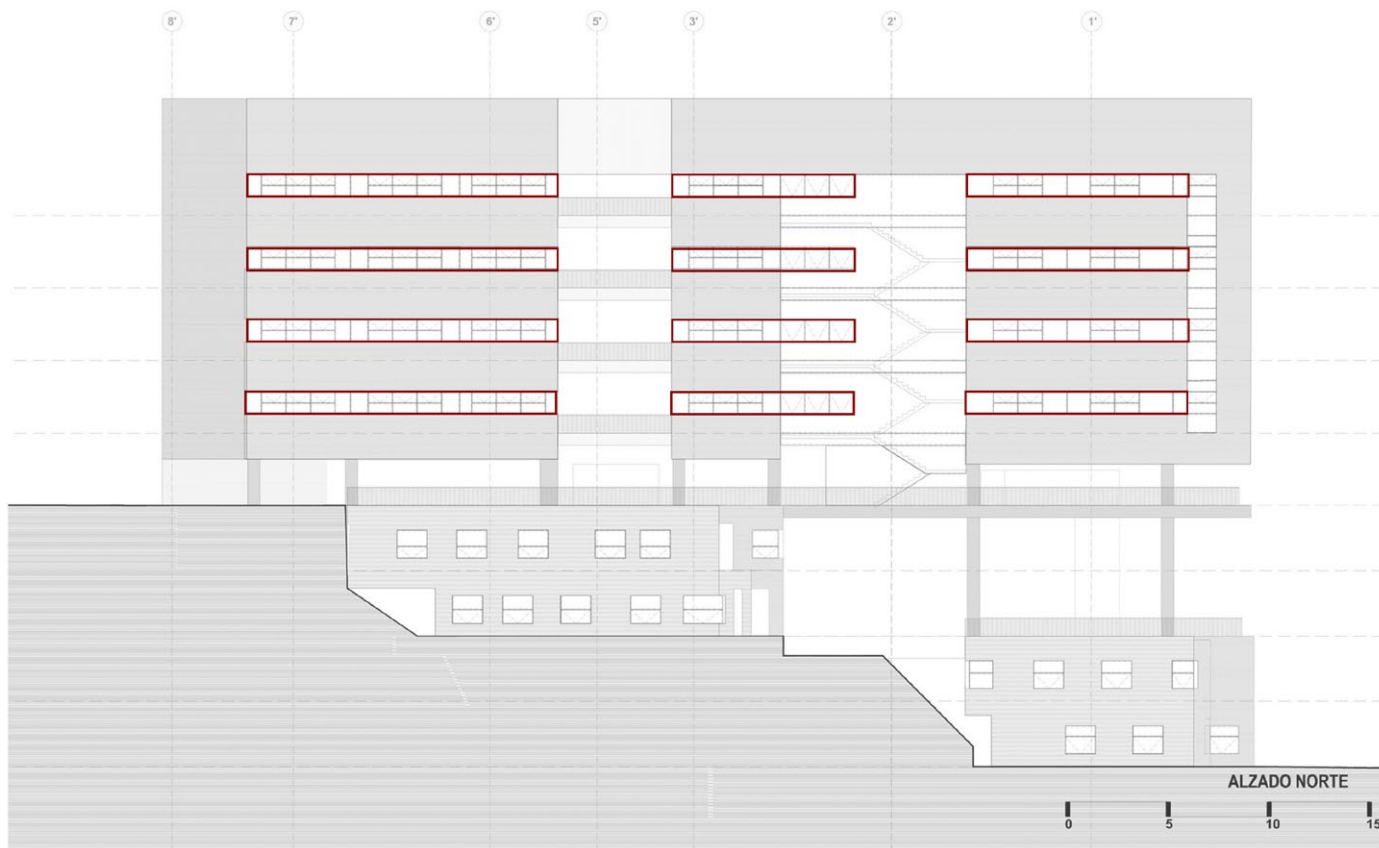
Planta arquitectónica, para representar el manejo de fachada mediante la utilización de celosías pre fabricadas.
